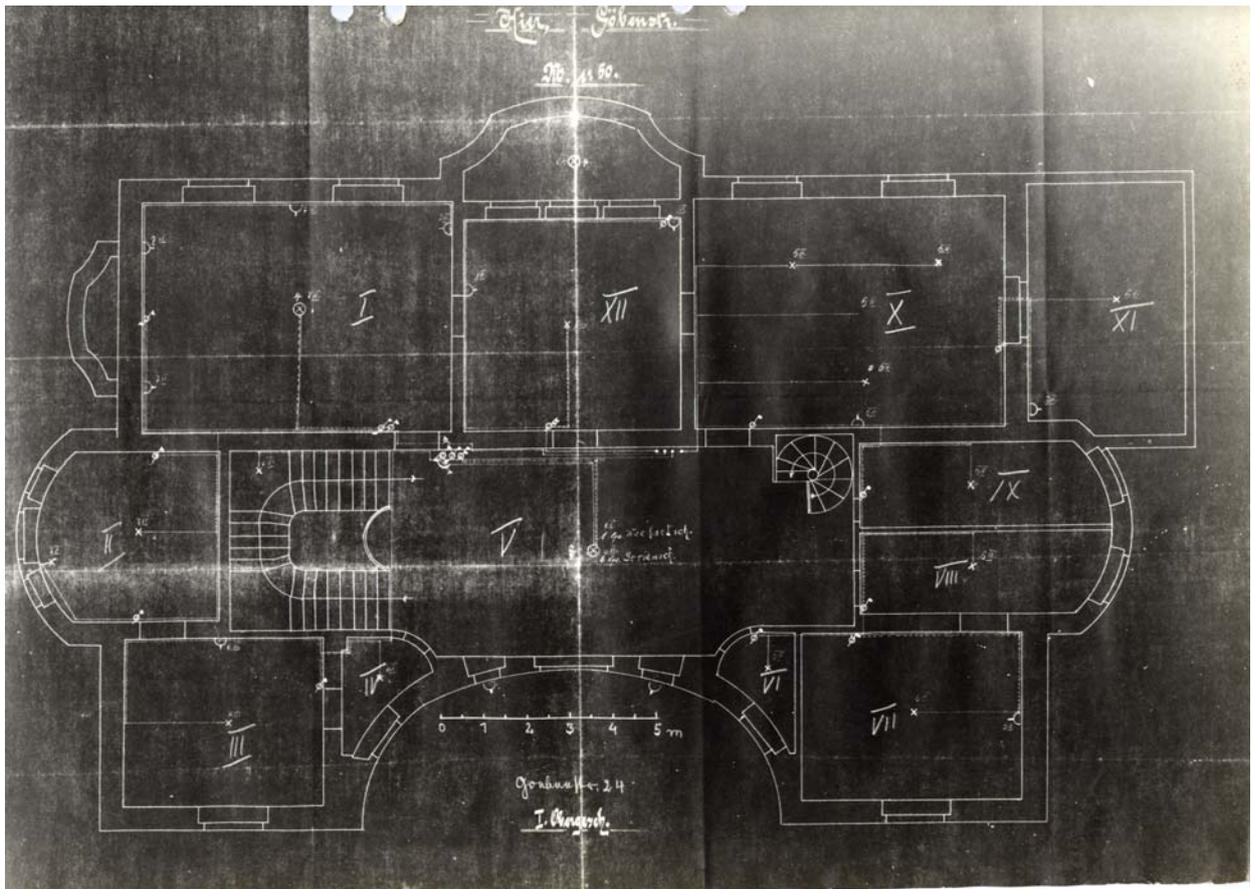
Haus Wichelhaus, Grundriss Obergeschoss, ohne Jahresangabe, vor 1948
